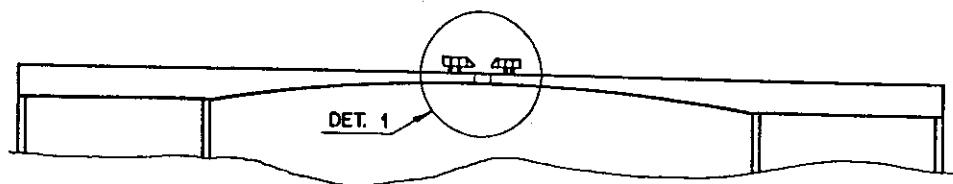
PONTE EM BALANÇOS PROGRESSIVOS COM ADUELAS CONCRETADAS NO LOCAL
